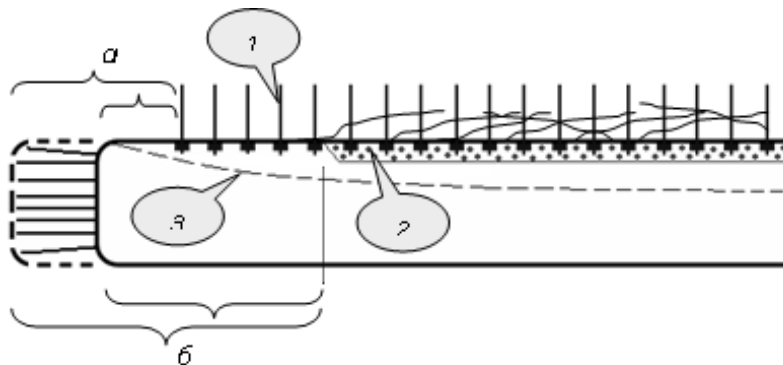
Отставание от забоя выработки до и после ухода за цикл: а) анкерной крепи 1; б) торкретбетонной крепи 2; 3 - смещения кровли
